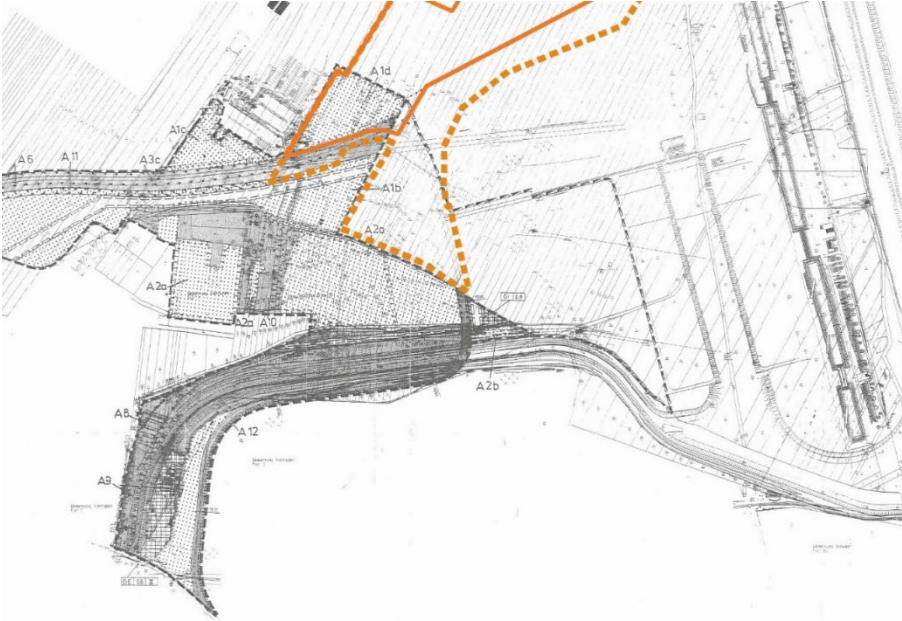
Darstellung des Untersuchungsraums und Bebauungsplan Nr. 4 „Hafenstraße“, Auszug aus der Planzeichnung (Teil A) (Quelle: Stadtverwaltung Schwedt/Oder, eigene Bearbeitung)
